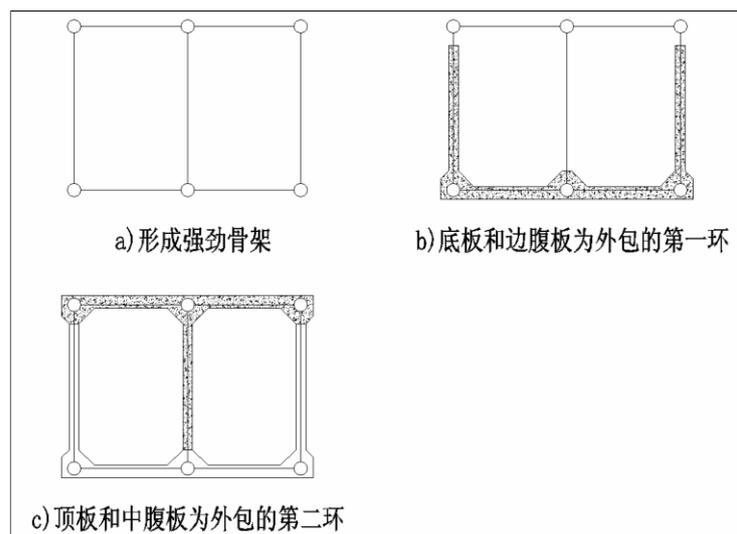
两环外包主拱混凝土的施工缝位置示意图 (1)
